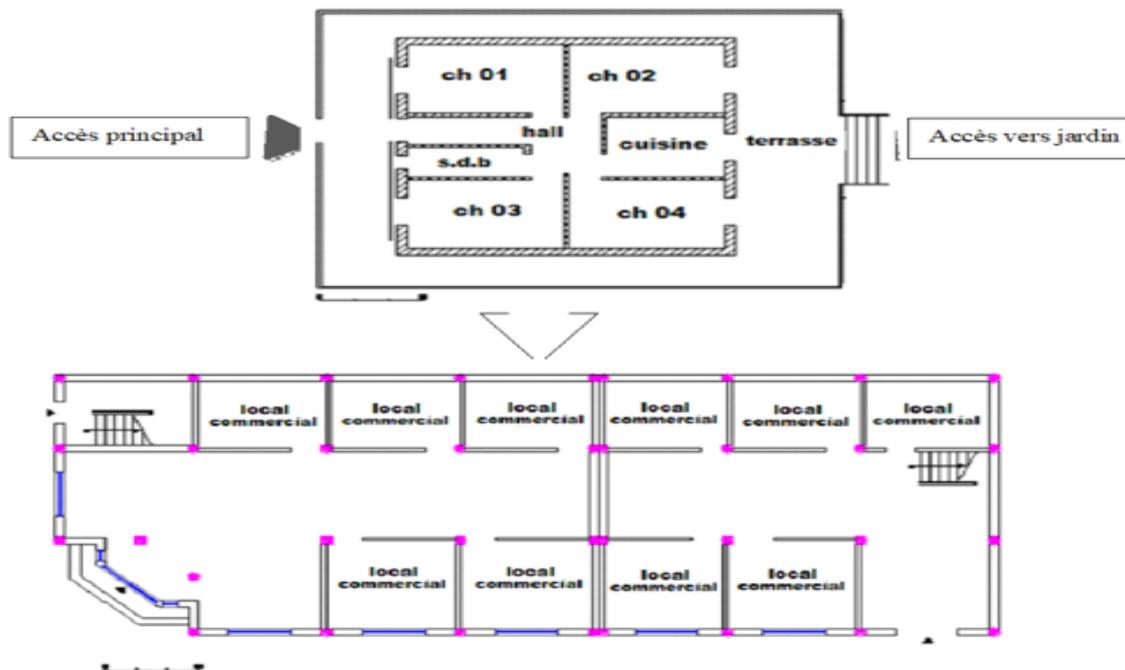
comparaison entre le plan initial et le plan de nouveau immeuble commercial
